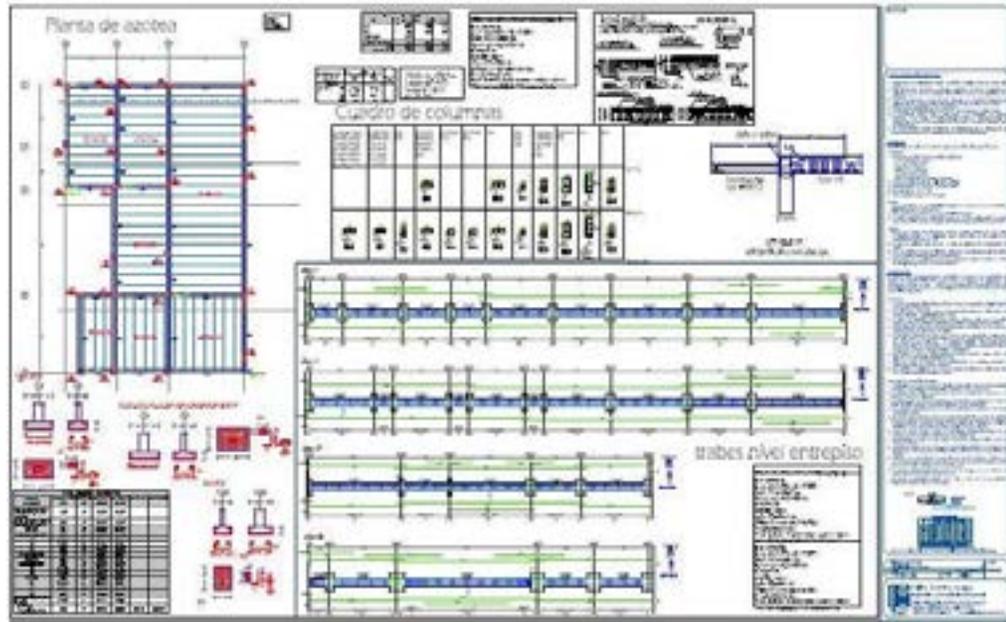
Ejemplo de plano estructural: detalles de losa, columnas y trabes tipo.
